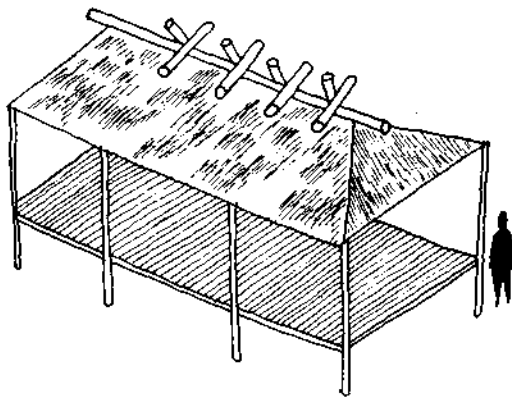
Casa Seminola, Florida (planta de 3 X 5 metros aproximadamente).
